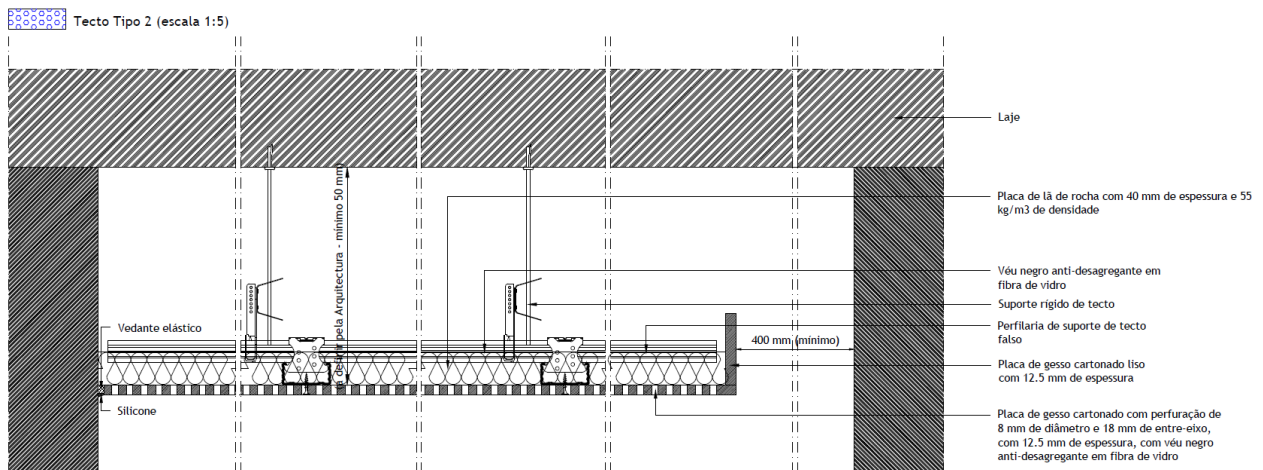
Pormenor construtivo de teto tipo 2 da Escola Secundária de Gondomar [53].
